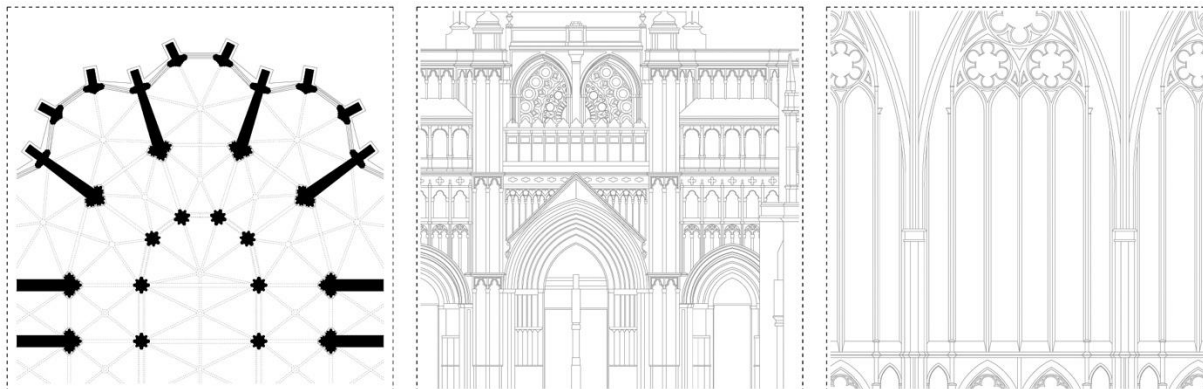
Nivel de detalle del redibujado. Planta correspondiente al deambulatorio de la Catedral de Burgos. Detalle del alzado central correspondiente a la fachada principal de la Catedral de Toledo. Detalle derecho correspondiente a la sección transversal de la nave de la Catedral de León.
